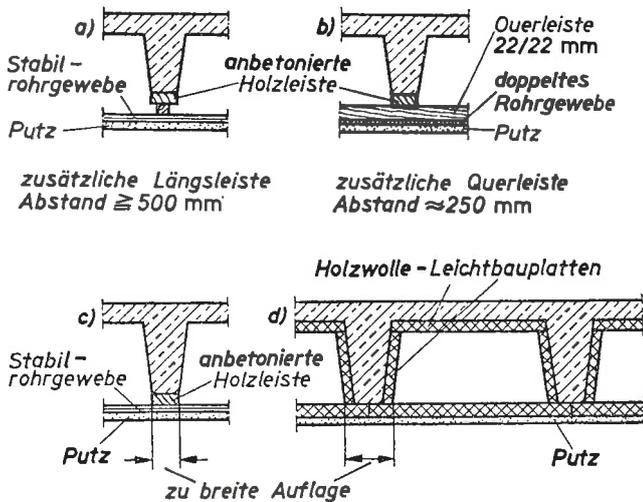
a bis 6 d. Befestigung von biegeweichen Unterdecken an Plattenbalken- oder Stahlbeton-Rippendecken
